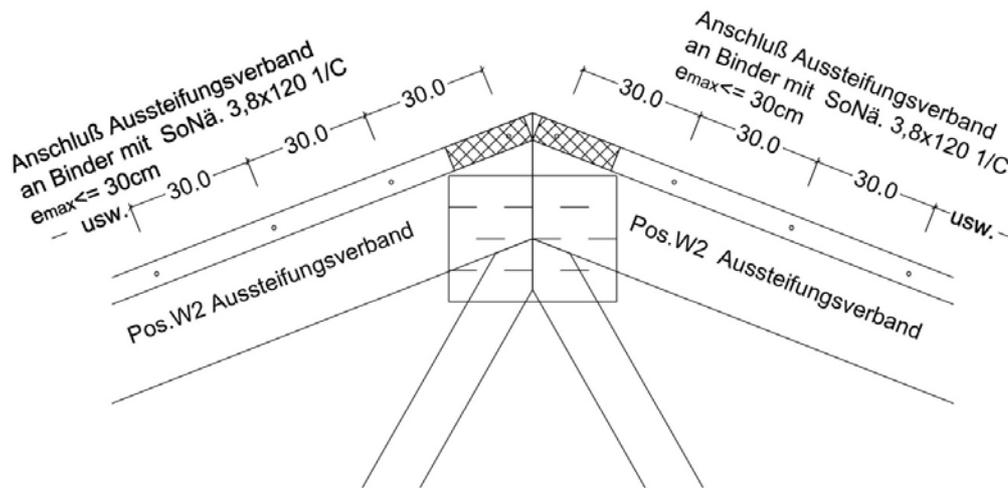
Vernagelung Verbandsgurte mit Obergurten der Hauptbinder
